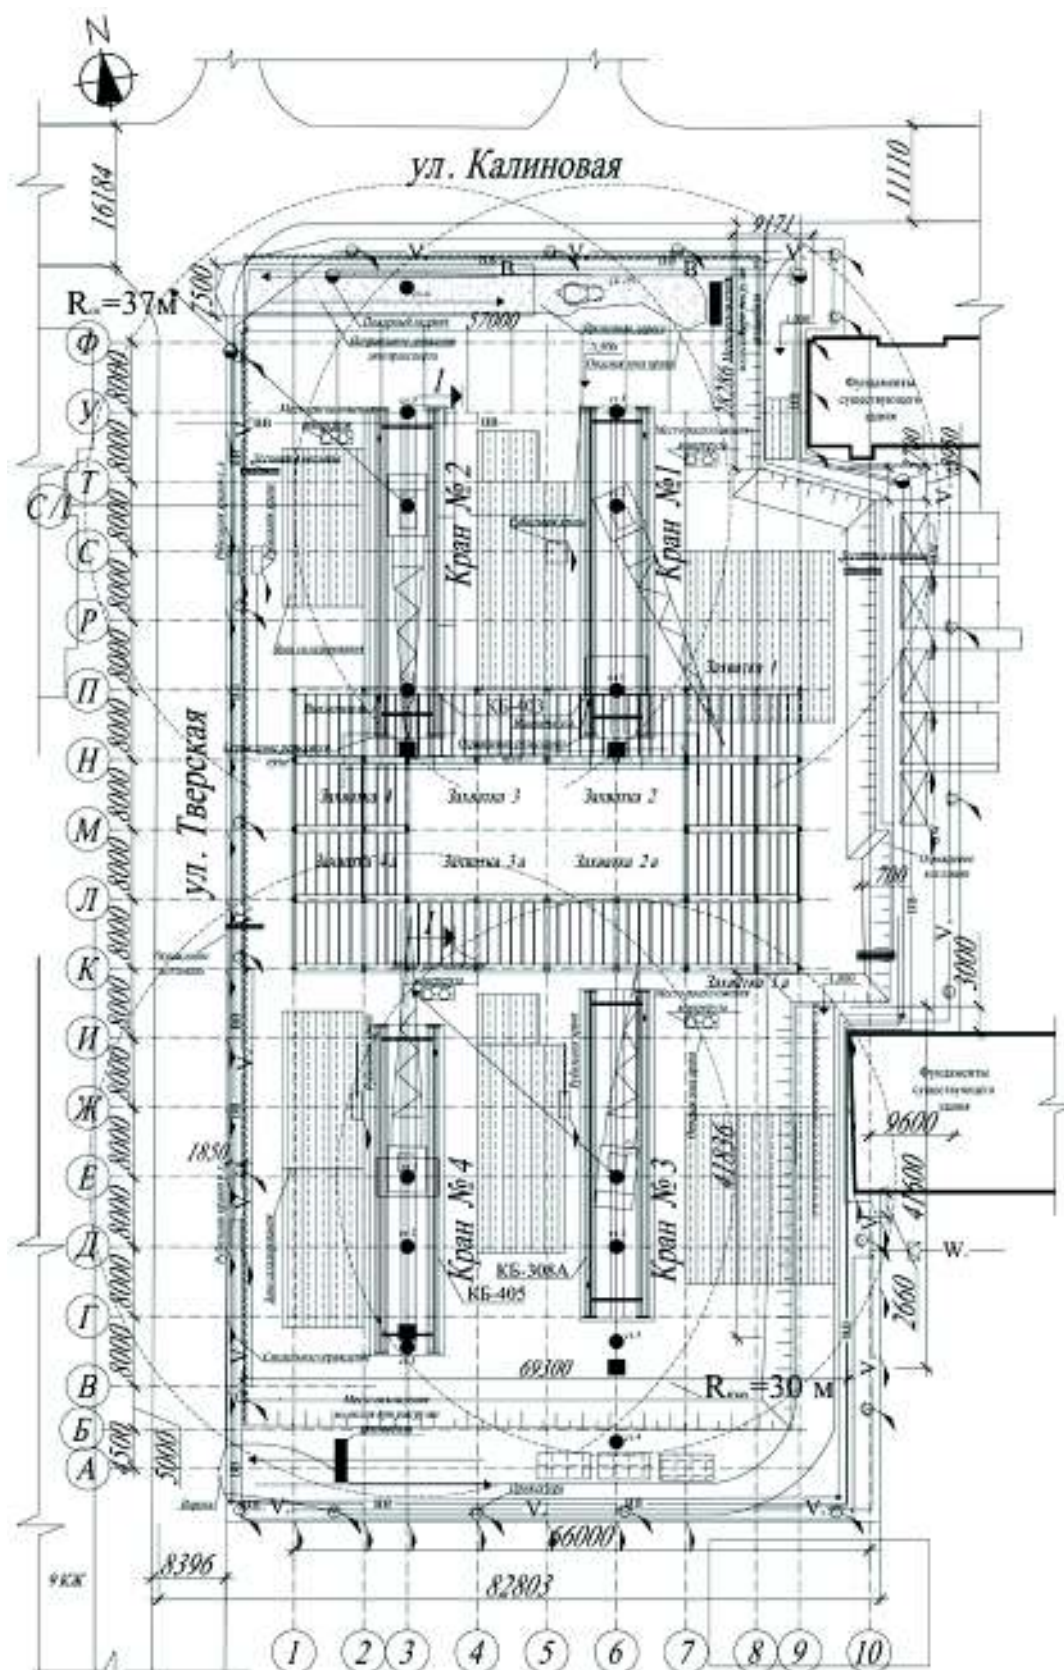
Схема строительного генерального плана на IV этапе устройства конструкций сборно-монолитного каркаса
